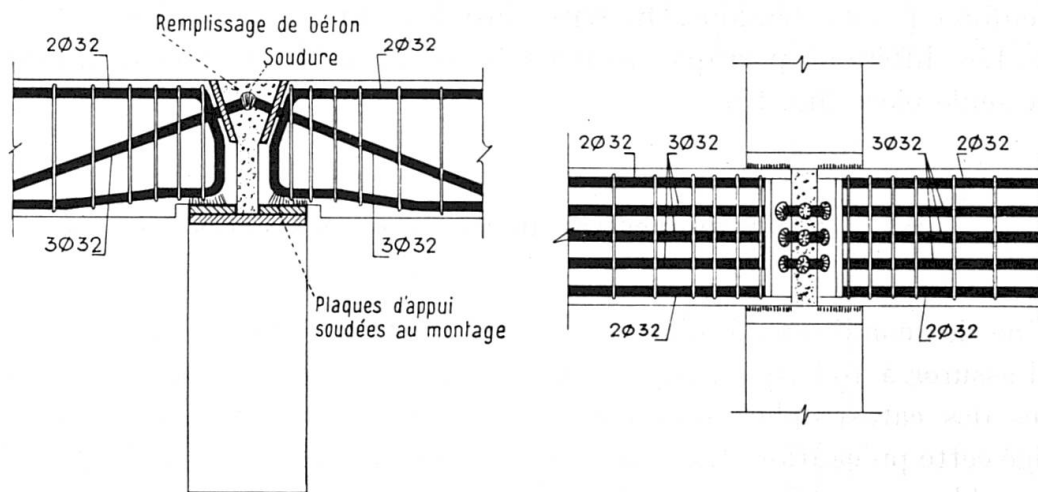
Assemblage des poutres longitudinales sur des arcs.
